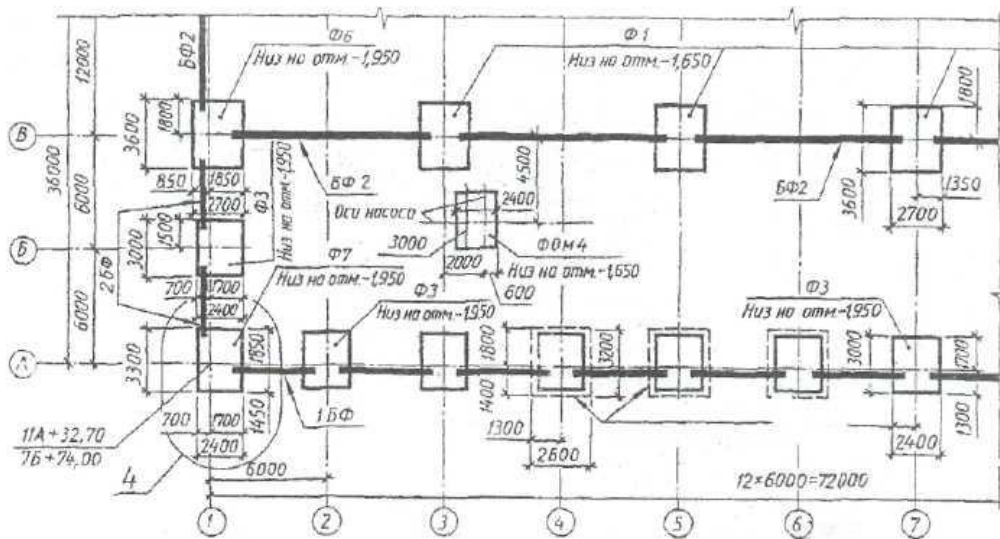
Фрагмент оформления плана фундаментов под колонны
